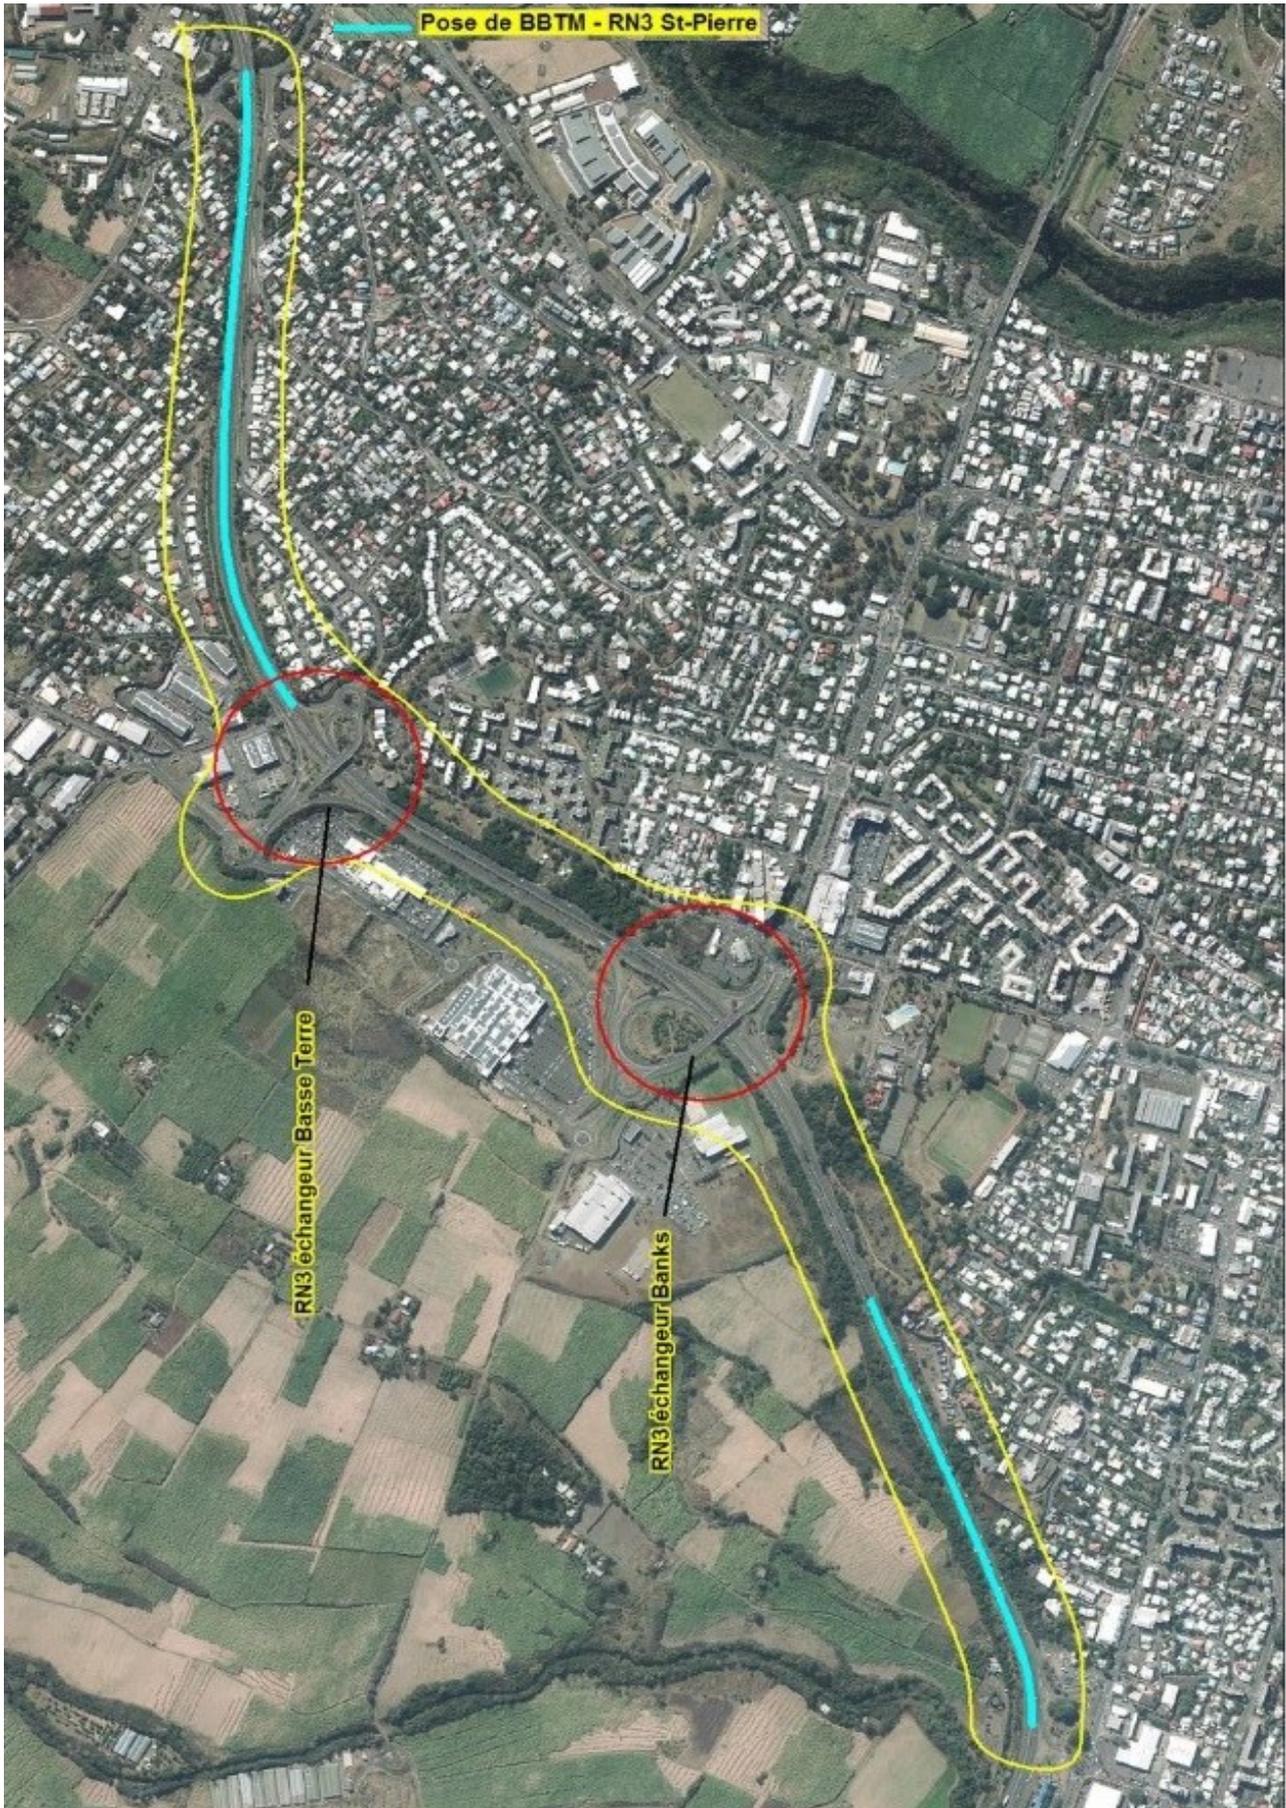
Plan de localisation des enrobés BBTM sur la RN3
